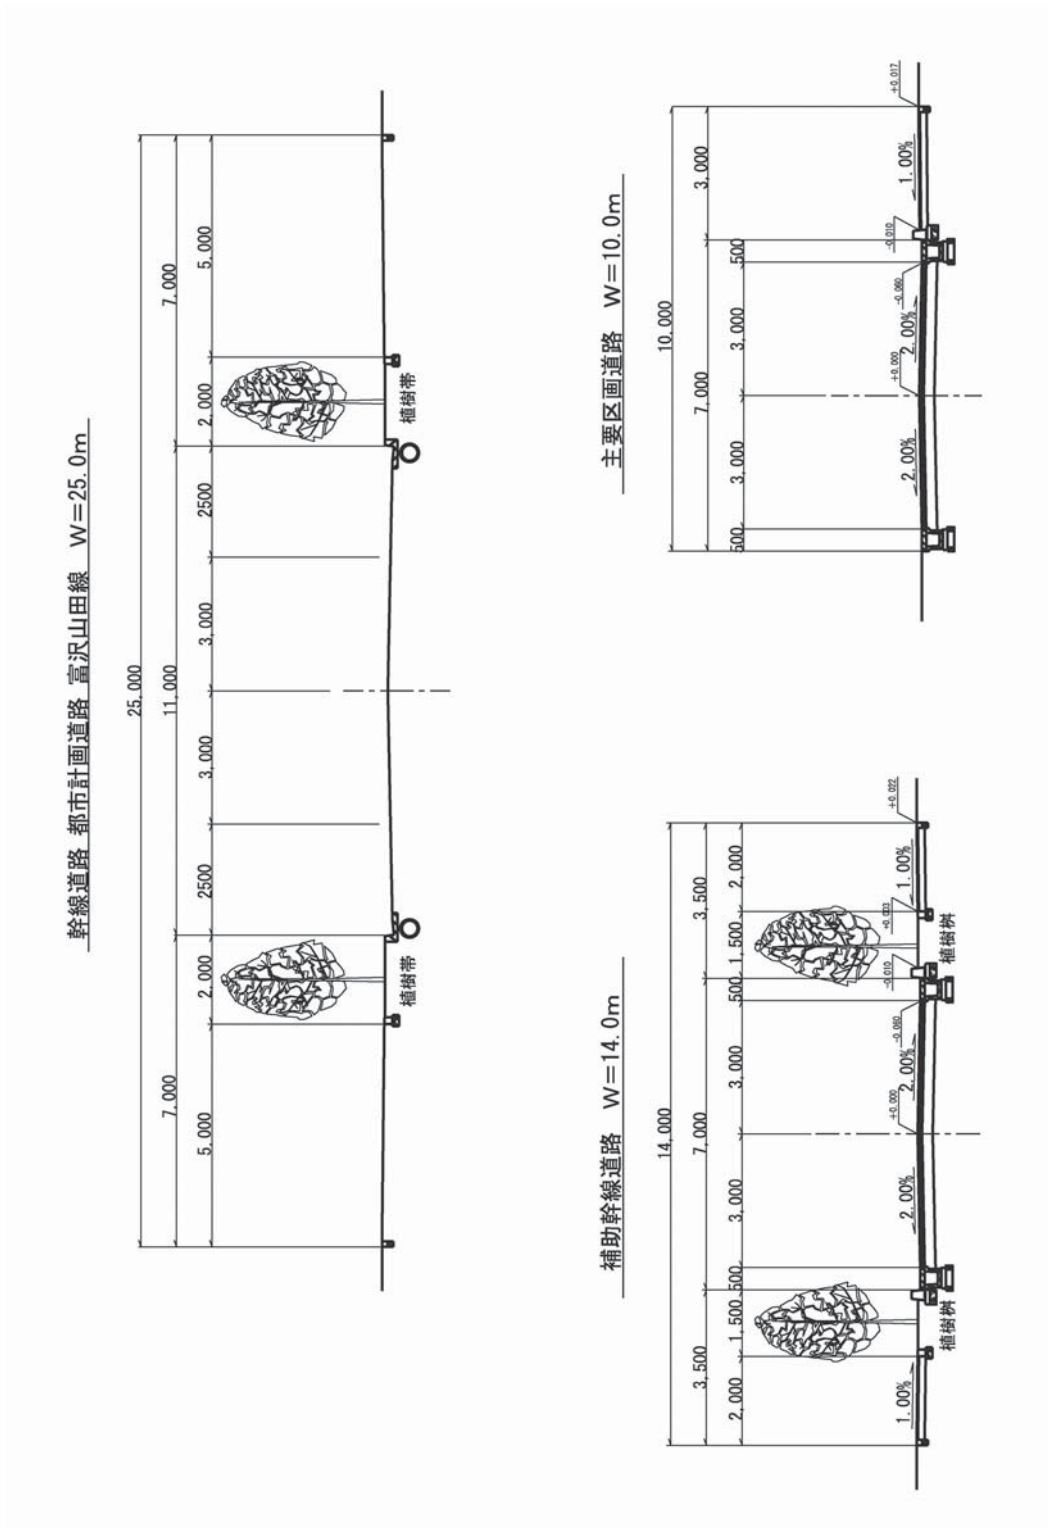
(1) 道路標準断面図 (変更前：評価書)
